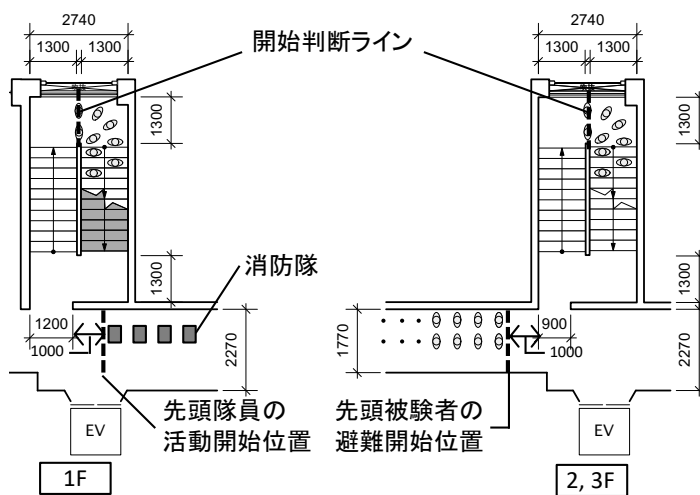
実験空間平面図と被計測者の初期位置(単位:mm)
